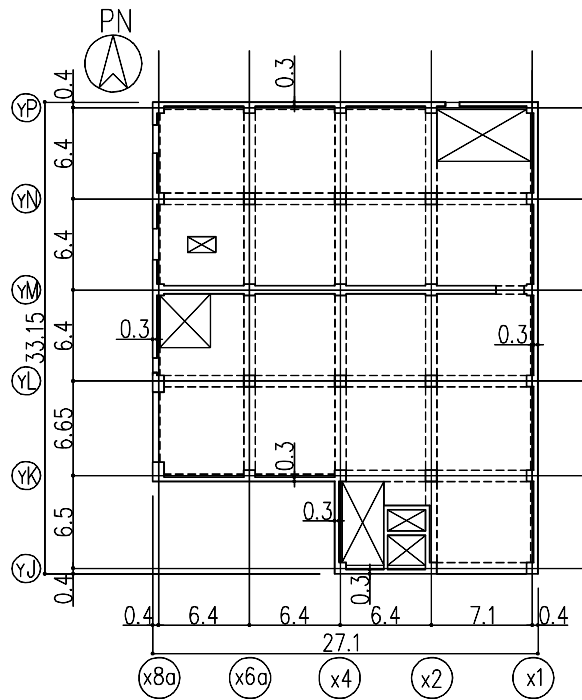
地上1階平面図 (G.L. +0.3) (单位 : m)
